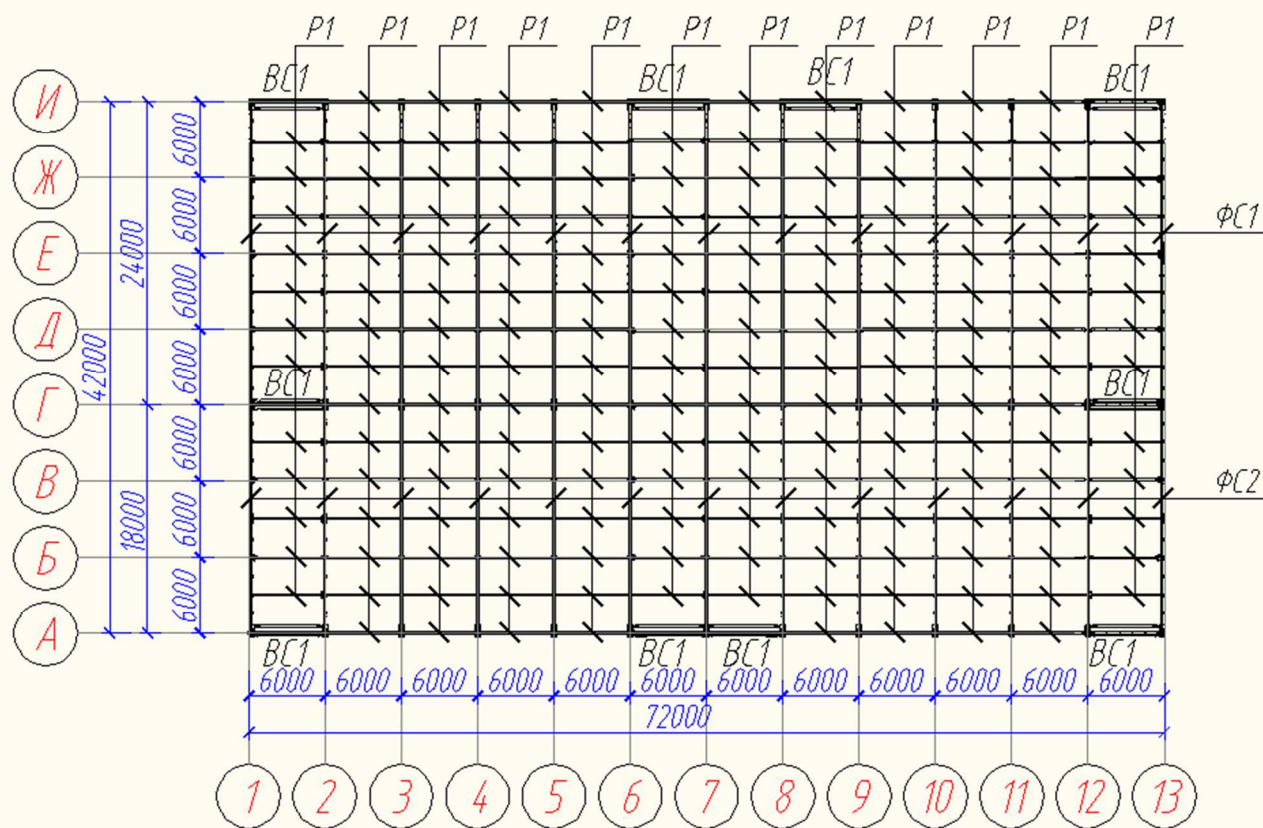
Схема расположения связей по нижним поясам стропильных ферм
